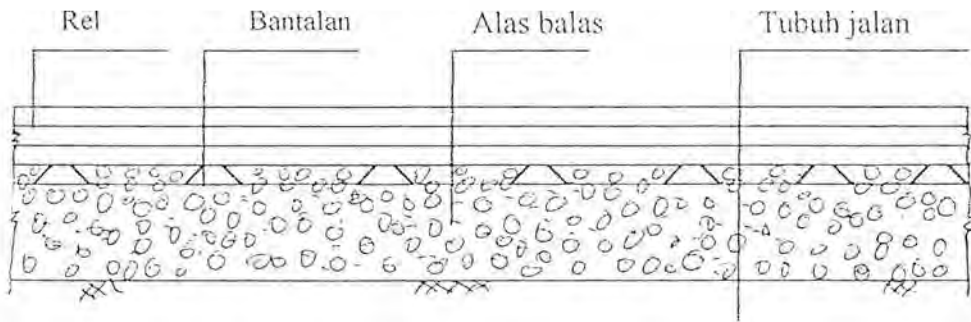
Potongan melintang konstruksi jalan kereta api
